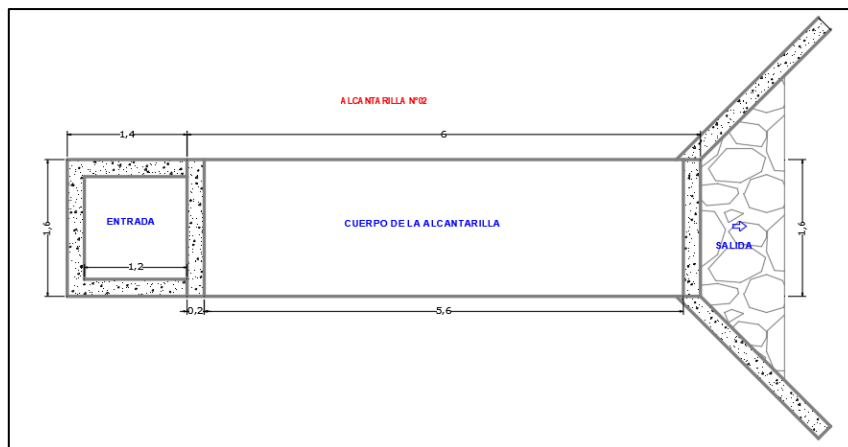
Vista en planta de la alcantarilla N°02 existente.
